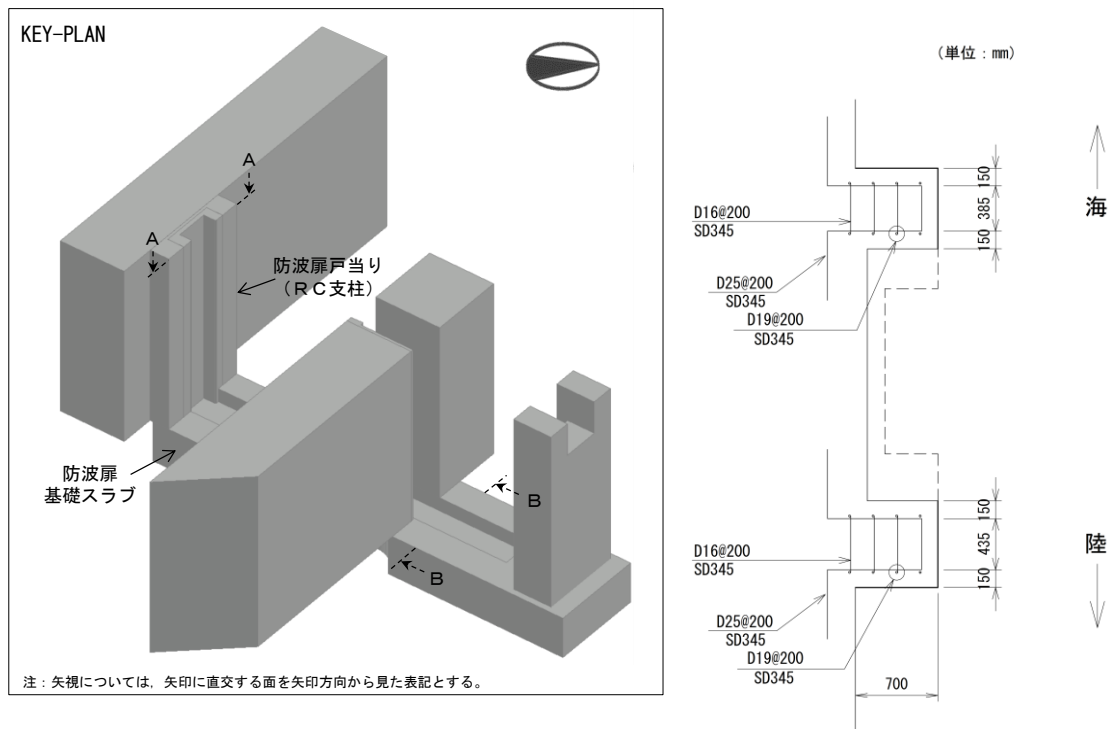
防波扉戸当り (RC 支柱) の概略配筋図 (A-A 断面)
